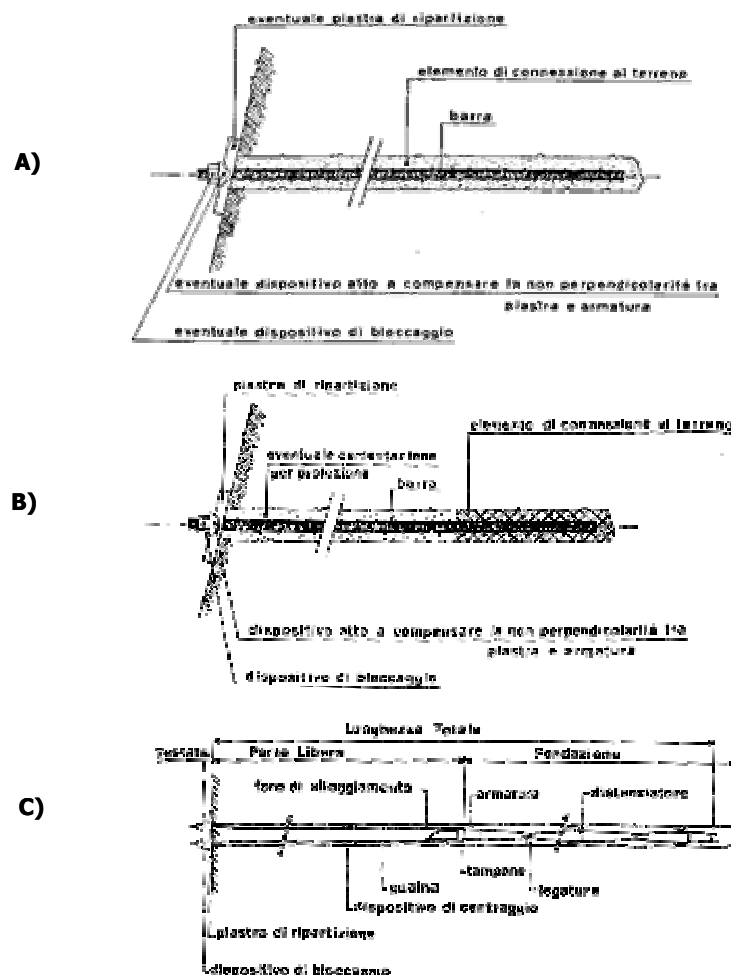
Ancoraggi passivi ed attivi. A) chiodo; B) bullone; C) tirante -
